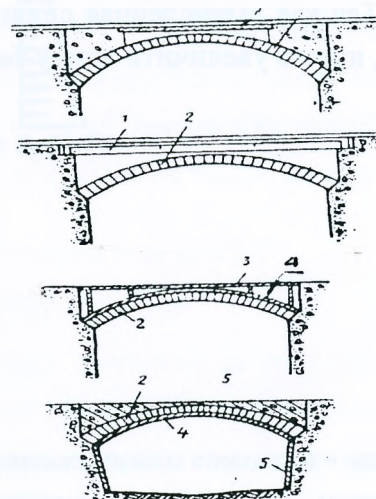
Усиление массивных сводов: 1 – железобетонное перекрытие; 2 – существующий свод; 3 – облегченное надсводное строение; 4 – свод усиления; 5 – уширенная часть опоры.
